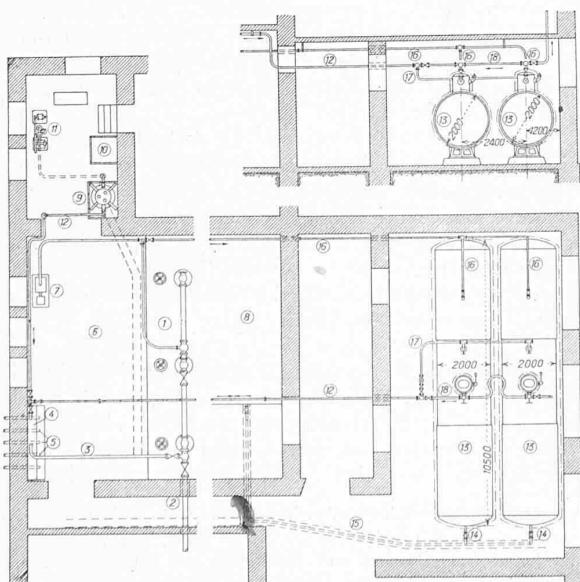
Grundriss des Kesselhauses. — 1:250.
